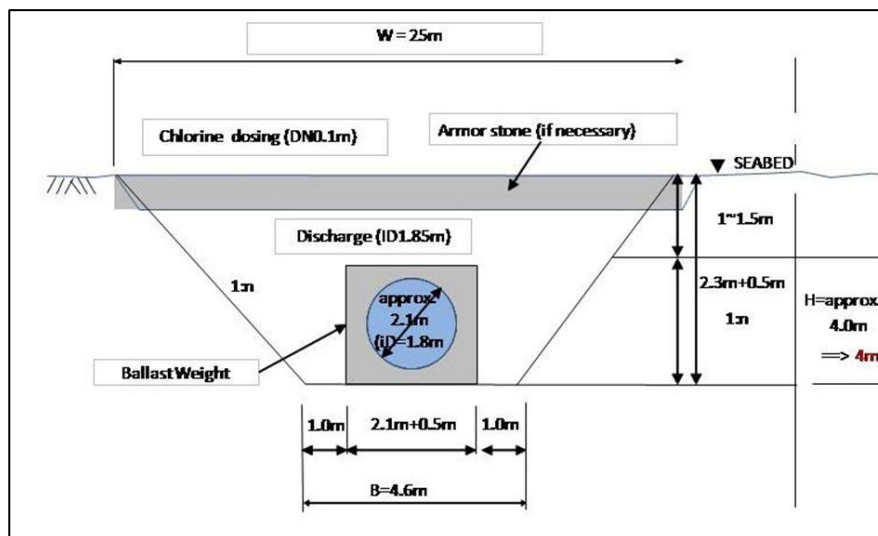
Coupe transversale de la conduite de rejet au niveau du dernier tronçon
